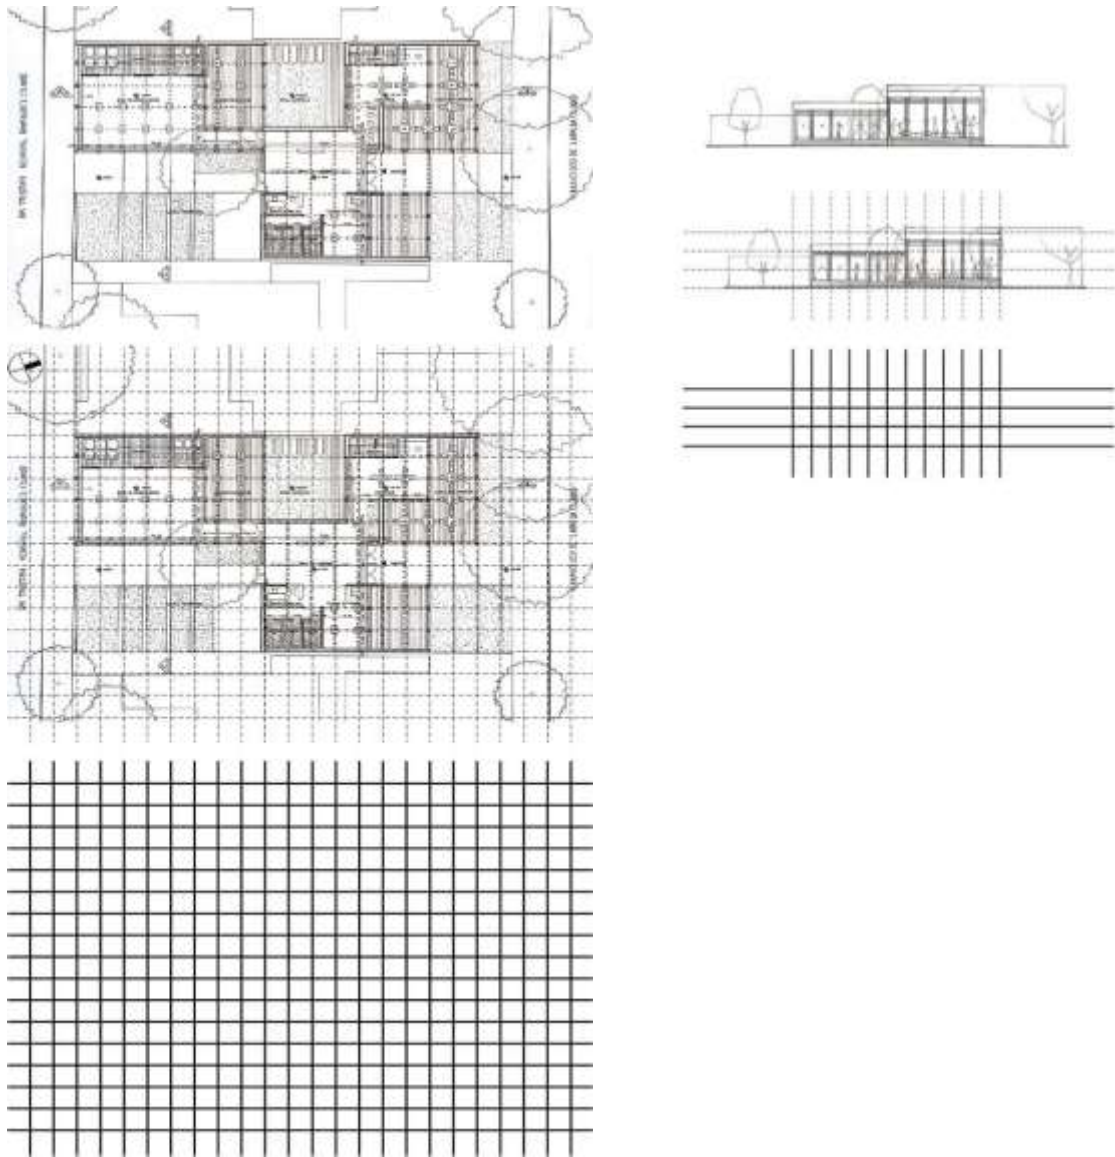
Módulos en la planta y alzado - Trabajo de Santiago Levio- Elaboración del estudiante y propia.
